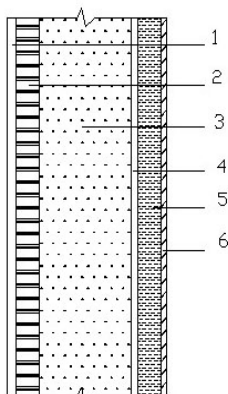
Конструкция стен дома: 1 – штукатурка – 20 мм; 2 – утеплитель тростниковый – 50 мм; 3 – каркасная система стены – 200 мм, стеновое утепление – 200 мм эковаты; 4 – OSB-плита – 15 мм; 5 – утеплитель из льняных волокон – 50 мм; 6 – ГКЛ (гипсокартон) – 12,5 мм
